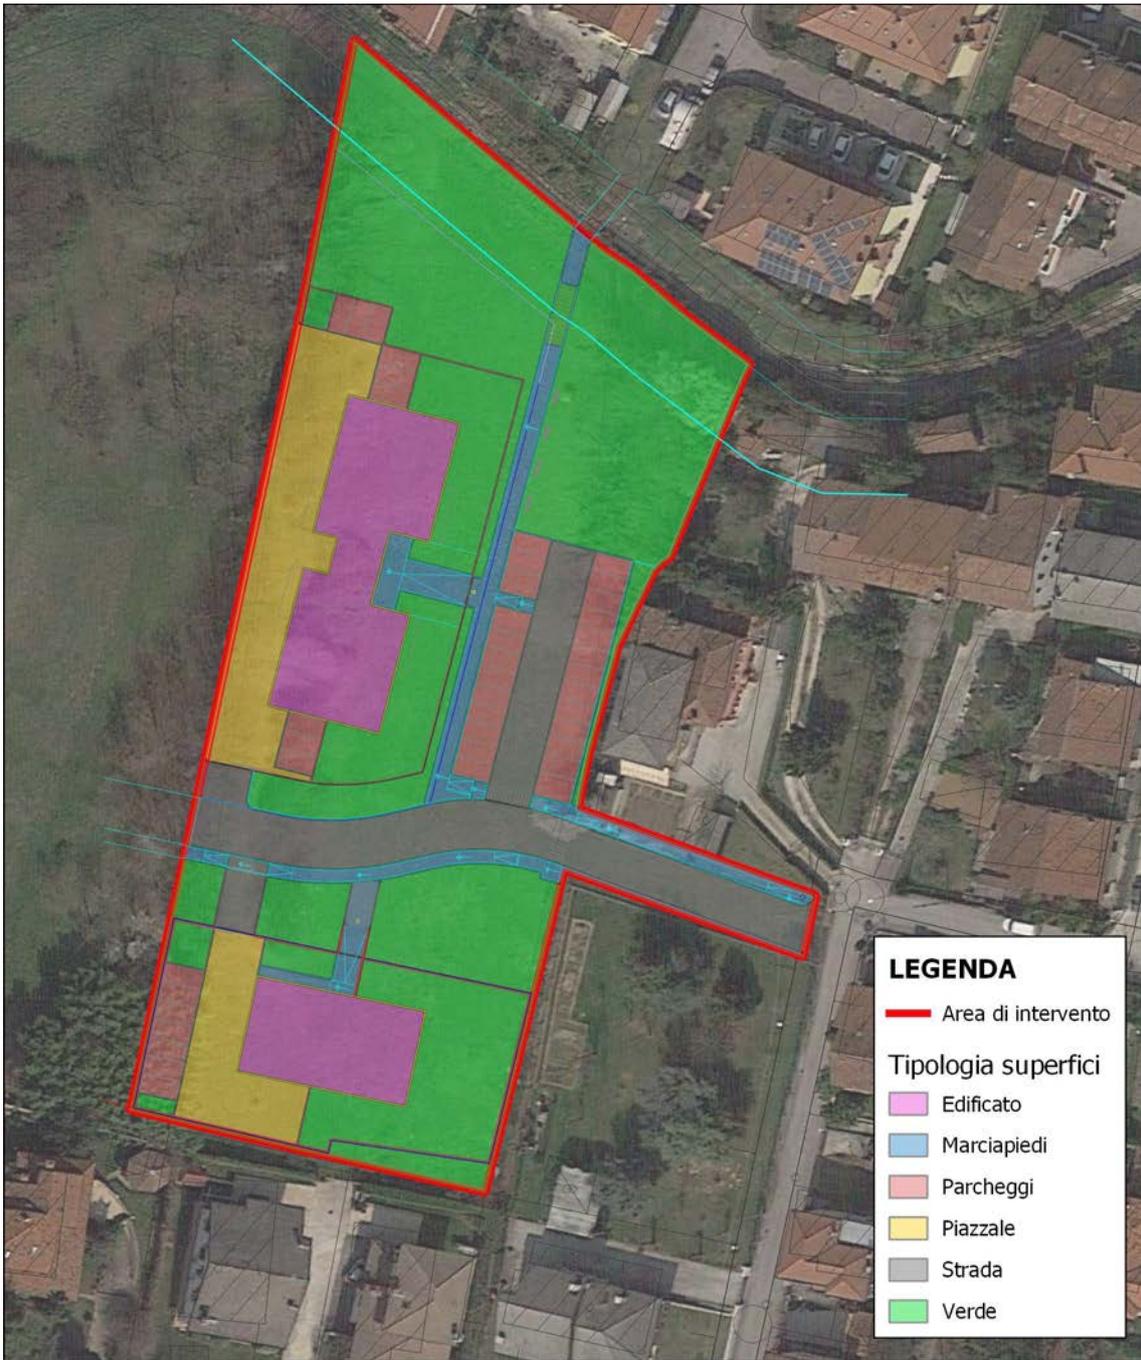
Planimetria dello stato di progetto (scala 1:1000)
